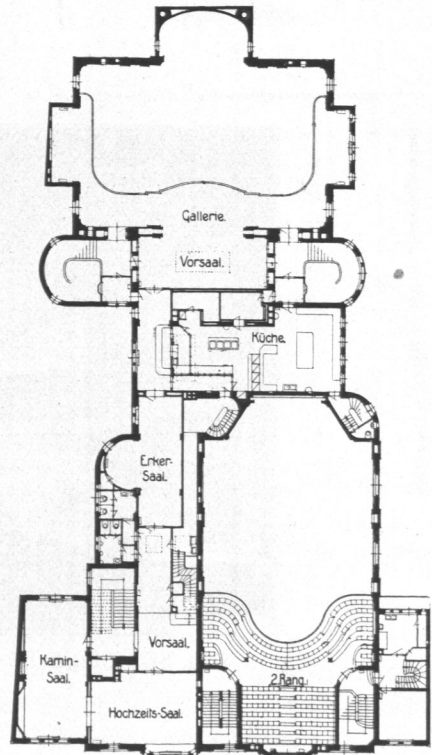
Bürgerfäle Eilbeck, zweites Obergeschoß, Grundriß.
